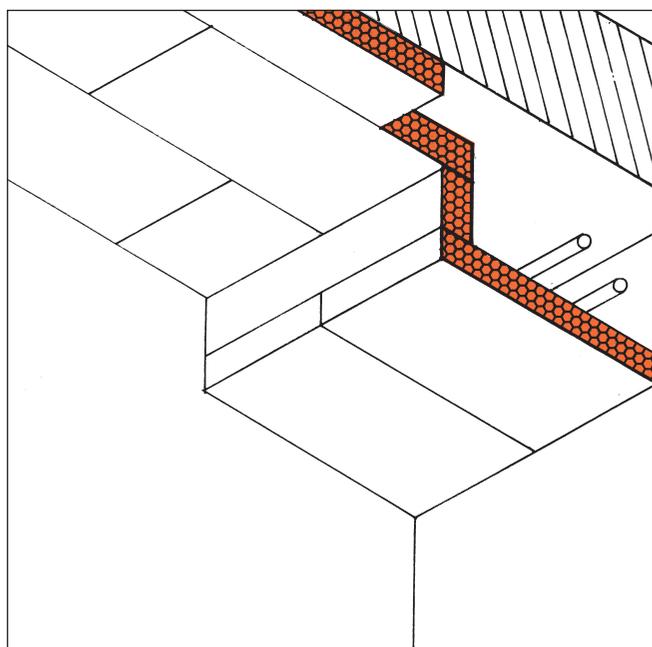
Isolamento di soffitto di scantinato. Le tubazioni a vista possono essere facilmente nascoste.
